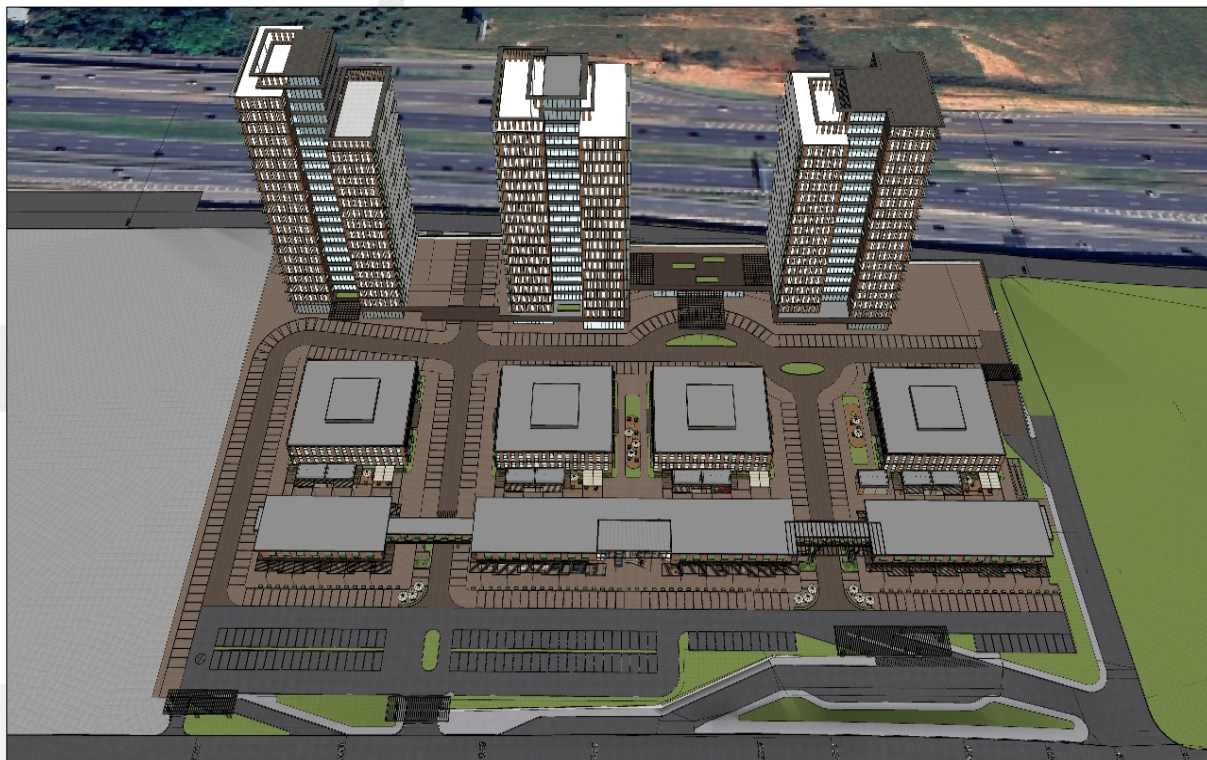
Imagem 3D – Fachada do empreendimento – Lote 2A e Lote 3.
